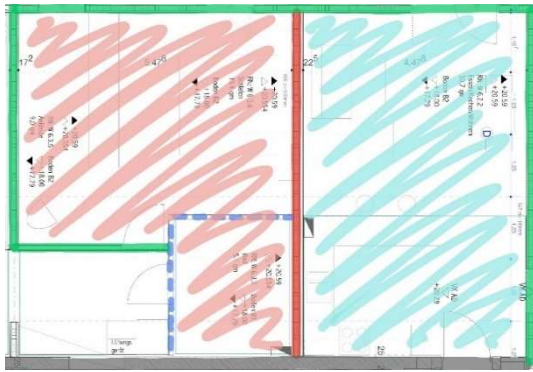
Grundriss des 6. Obergeschosses mit ungünstig liegendem Bad (blau)
